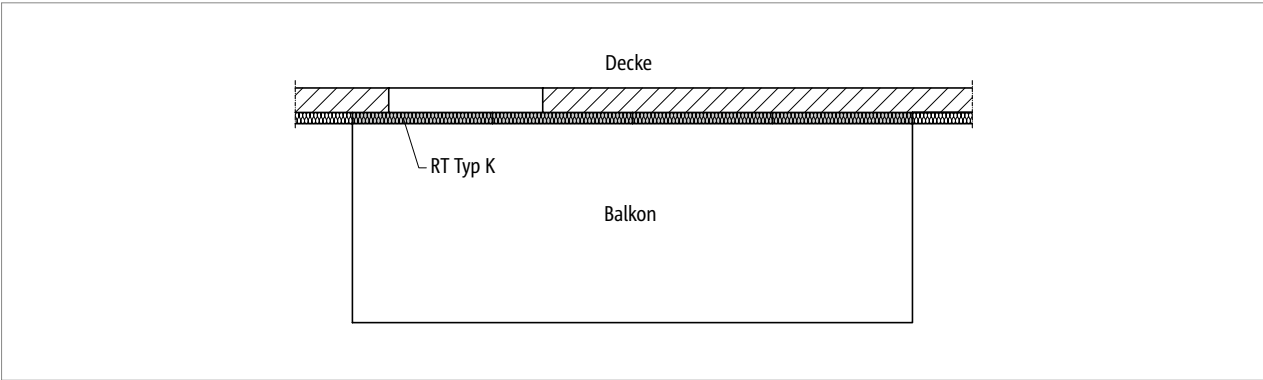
Schöck Isokorb® RT Typ K: Balkon frei auskragend bei Erneuerung eines Bestandsbalkons
